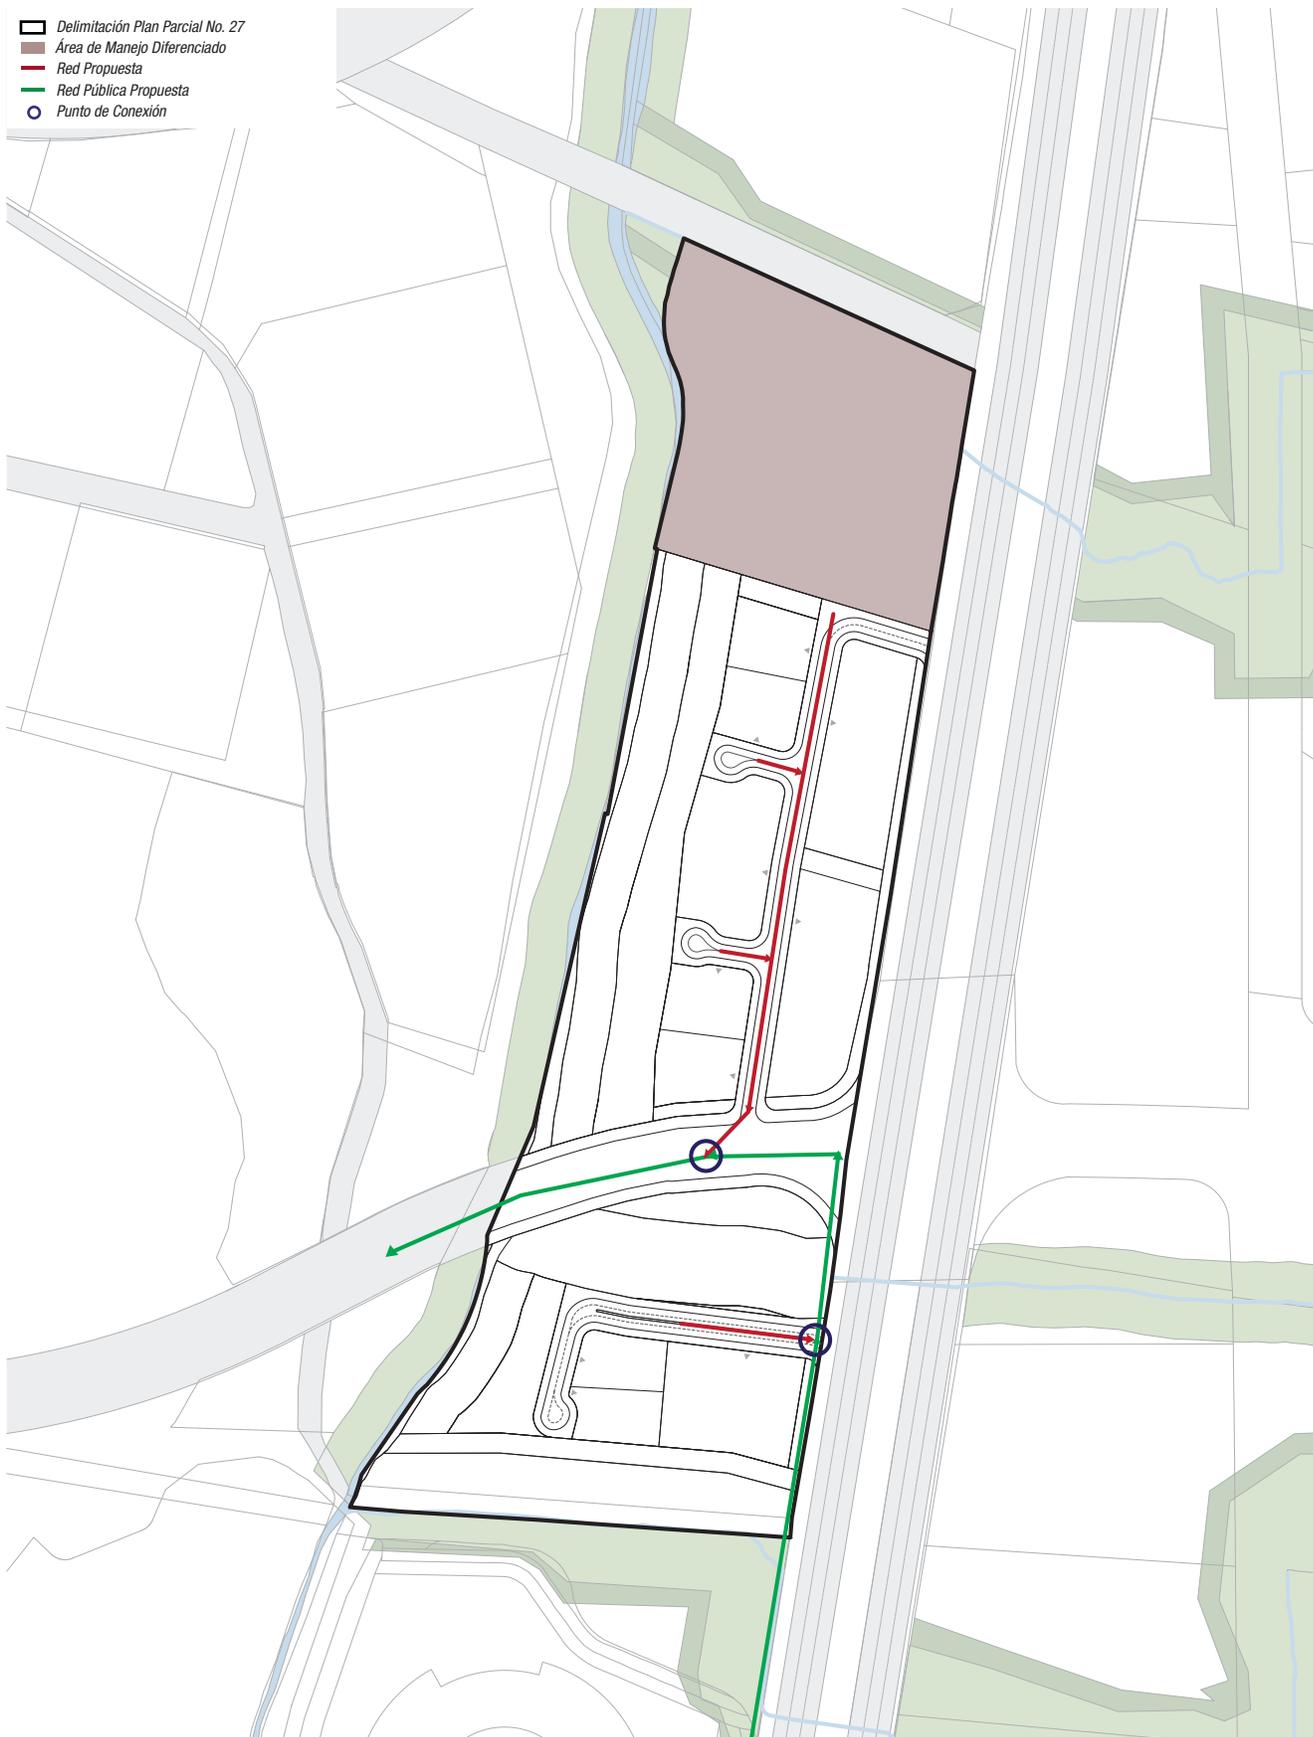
Sistema de Alcantarillado Sanitario - Puntos de Conexión
